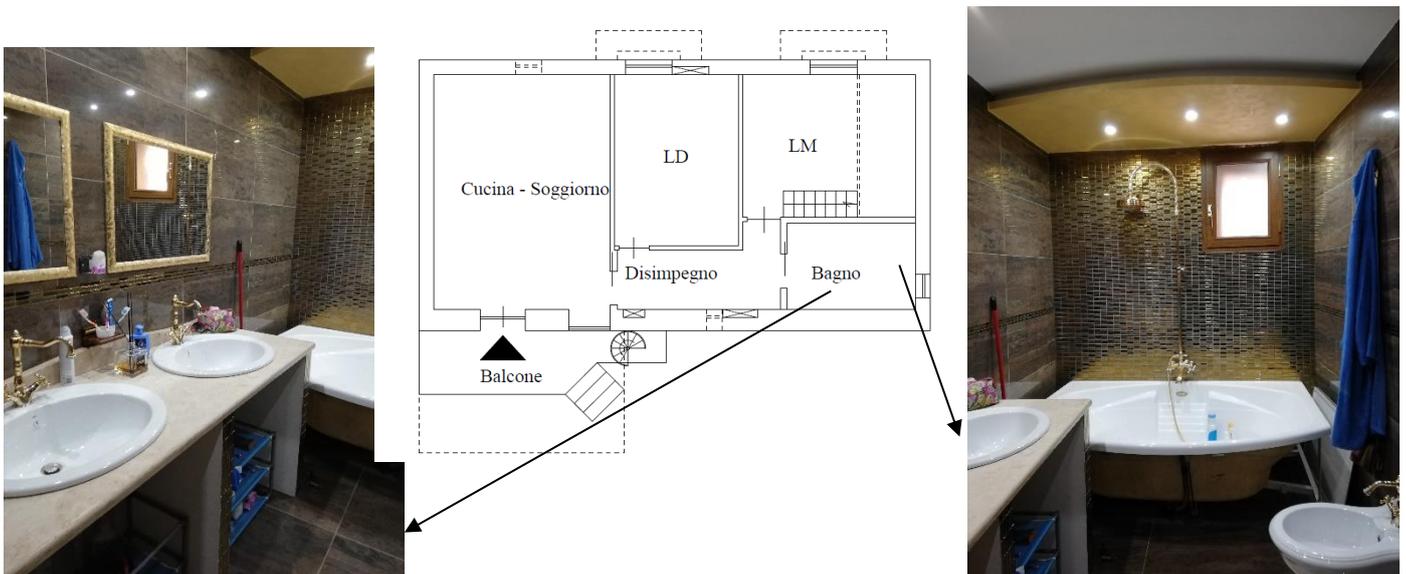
Individuazione fotografica degli interni del bene oggetto di pignoramento.
